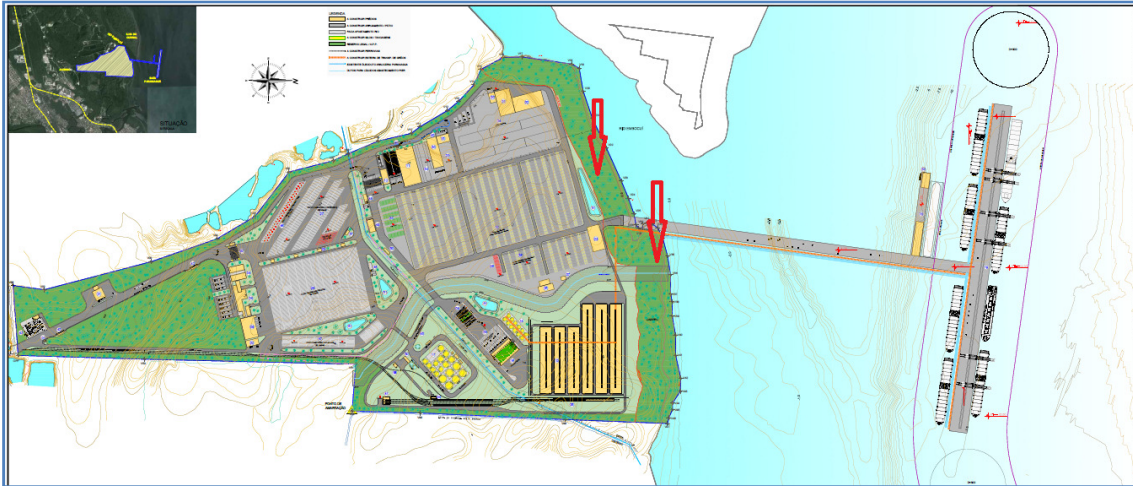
Planta de implantação com destaque de faixa de 100m.
